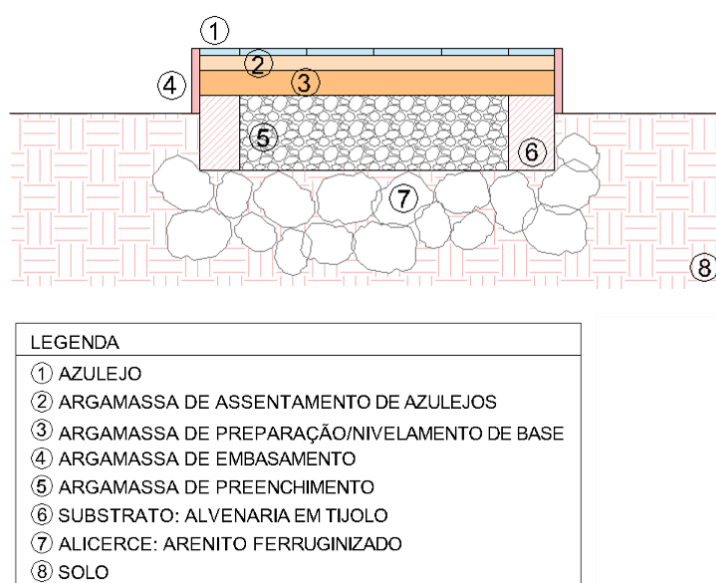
esquema das múltiplas aplicações de argamassas em uma sepultura azulejada. As funções desempenhadas são predominantemente do tipo estrutural (assentamento de azulejos, preenchimento, preparação de base, assentamento da alvenaria e do alicerce).
